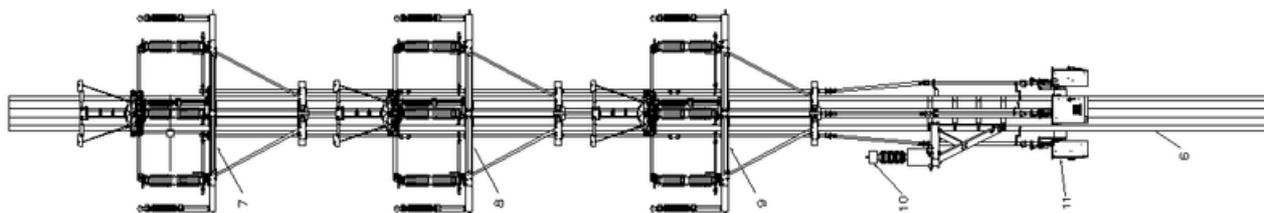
Vista de un sistema montado en poste de acero: 6. Poste de acero, 7. Cuchillas seccionadoras de Fase Superior, 8. Cuchillas seccionadoras de Fase del Medio, 9. Cuchillas seccionadoras de Fase Inferior, 10. Dispositivo para Fuente de Alimentación, 11. Gabinete.
